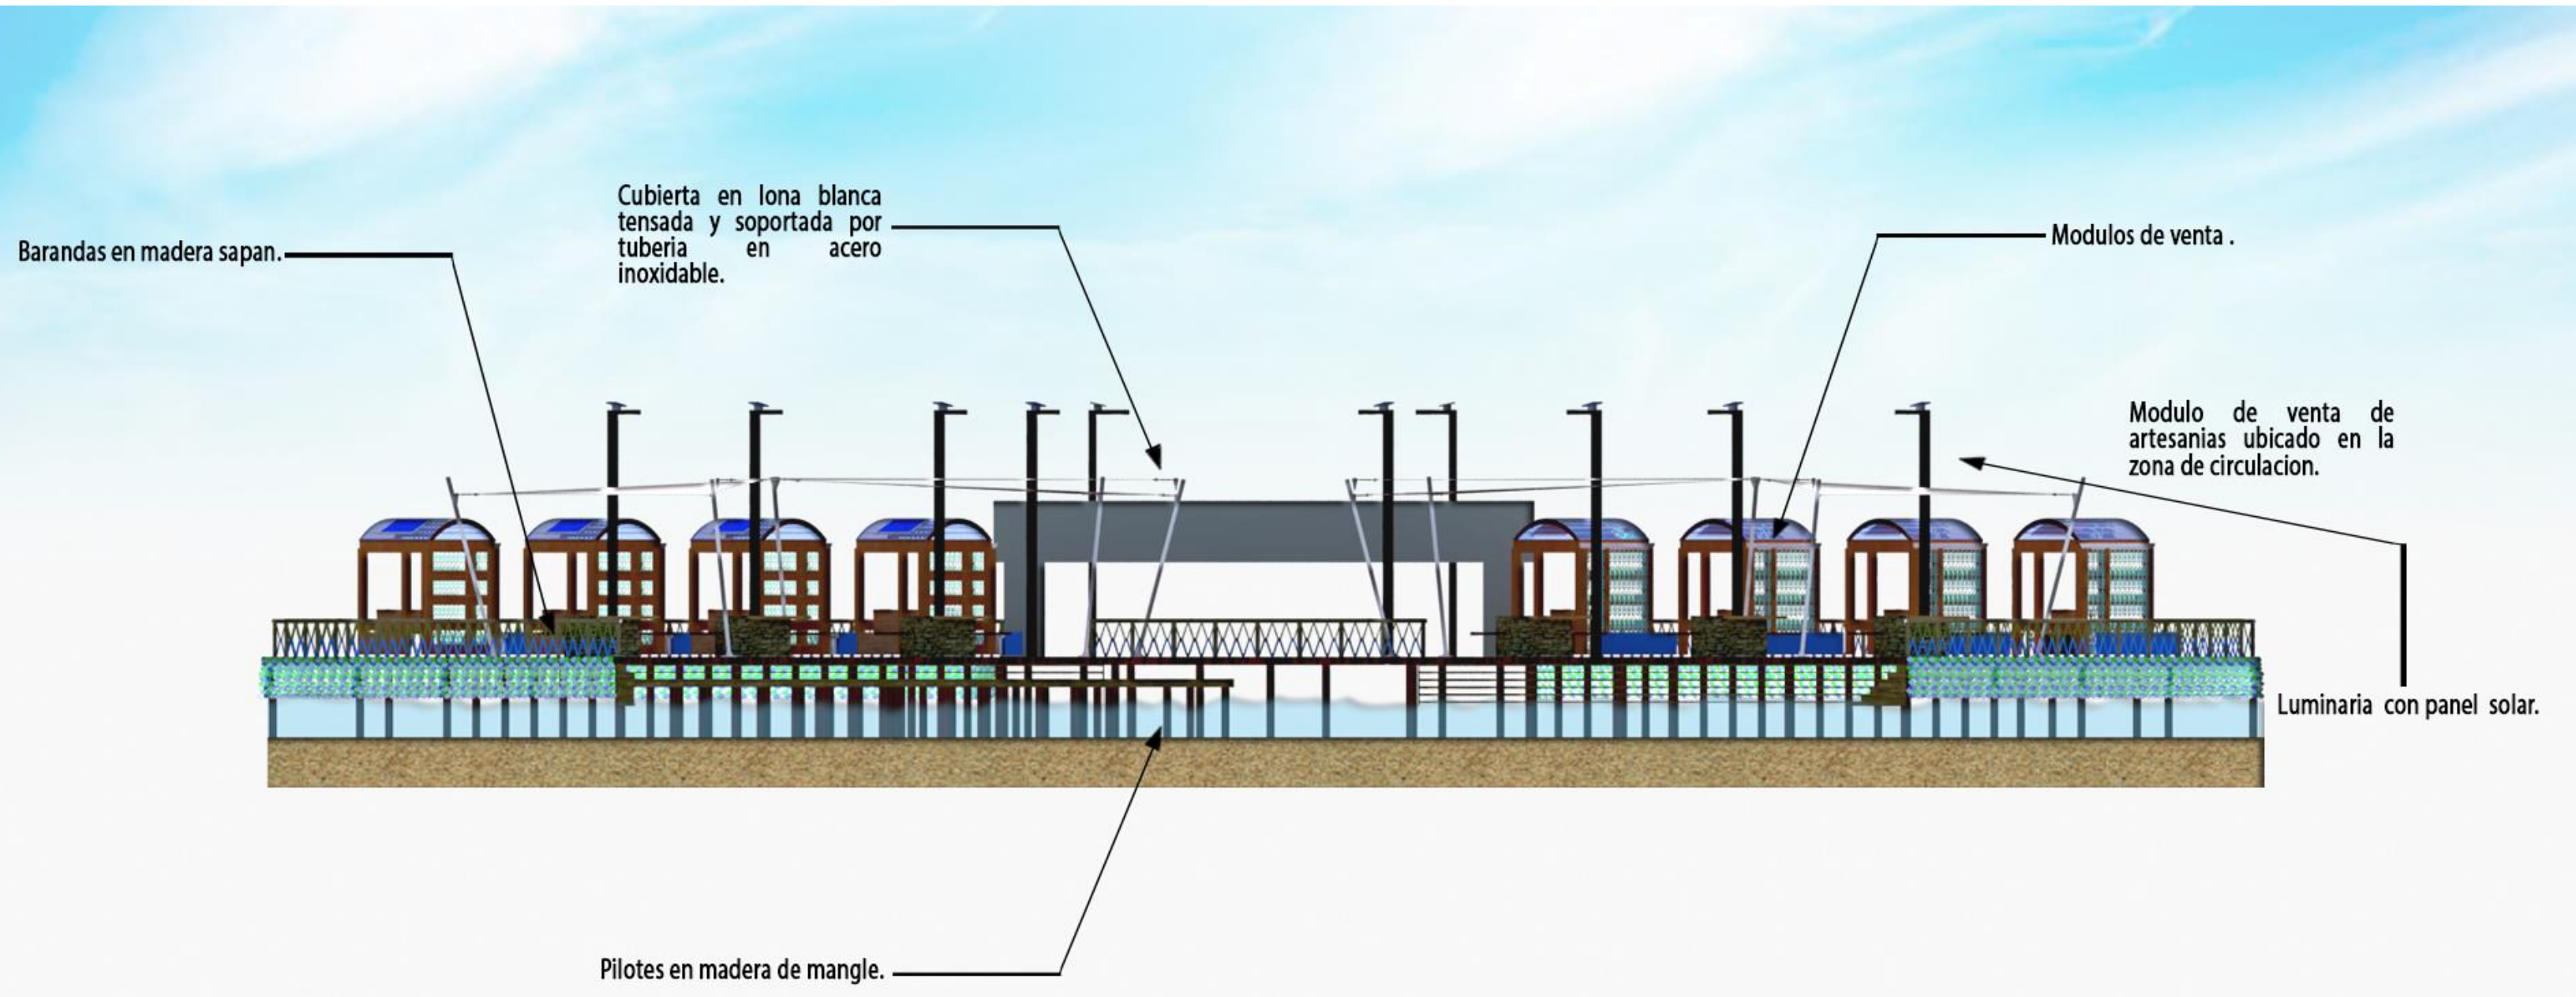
Alzado Plataforma 2. Fuente: Elaboración propia
